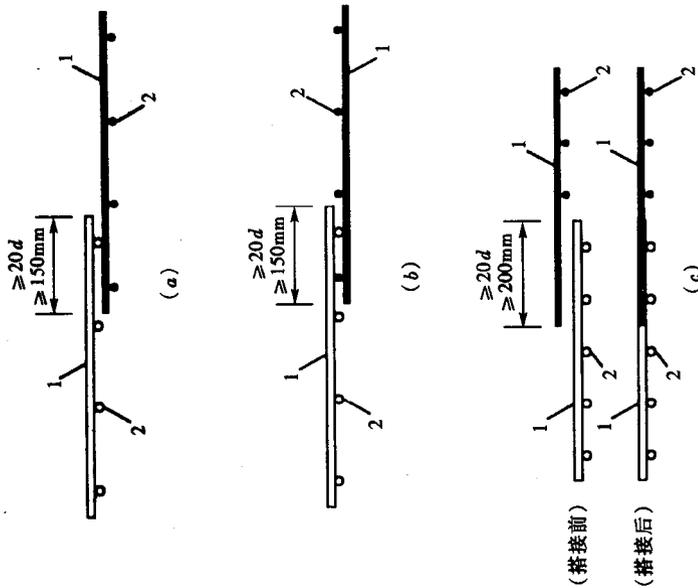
钢筋焊接网在非受力方向的搭接
